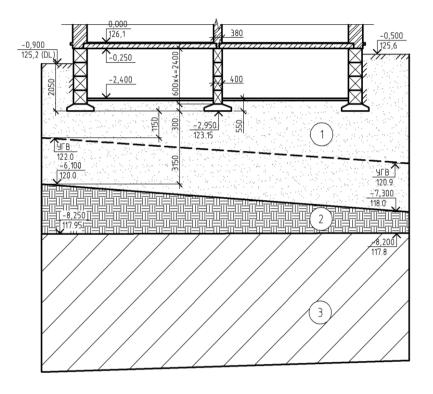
Схема к предварительному выбору ФМЗ под несущие стены
